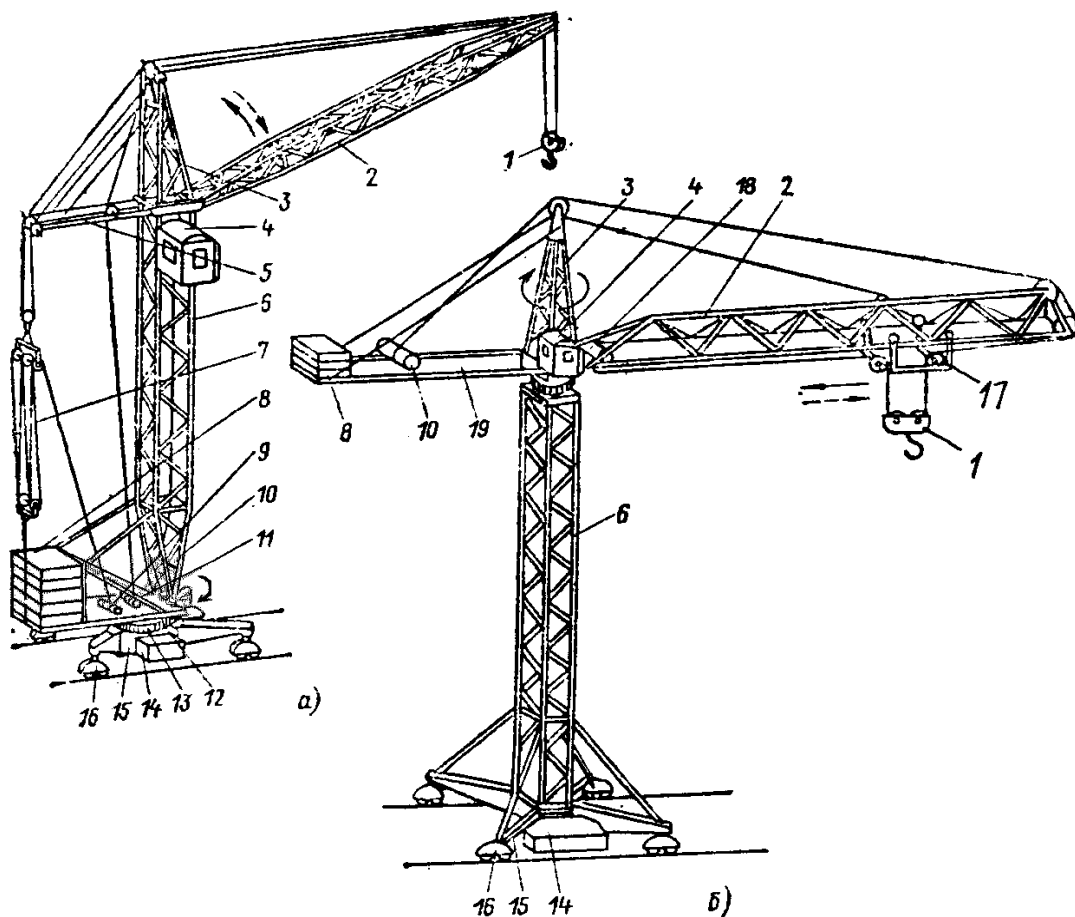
Башенные краны: а – с поворотной башней и подъемной стрелой; б – с неповоротной башней и балочной стрелой
